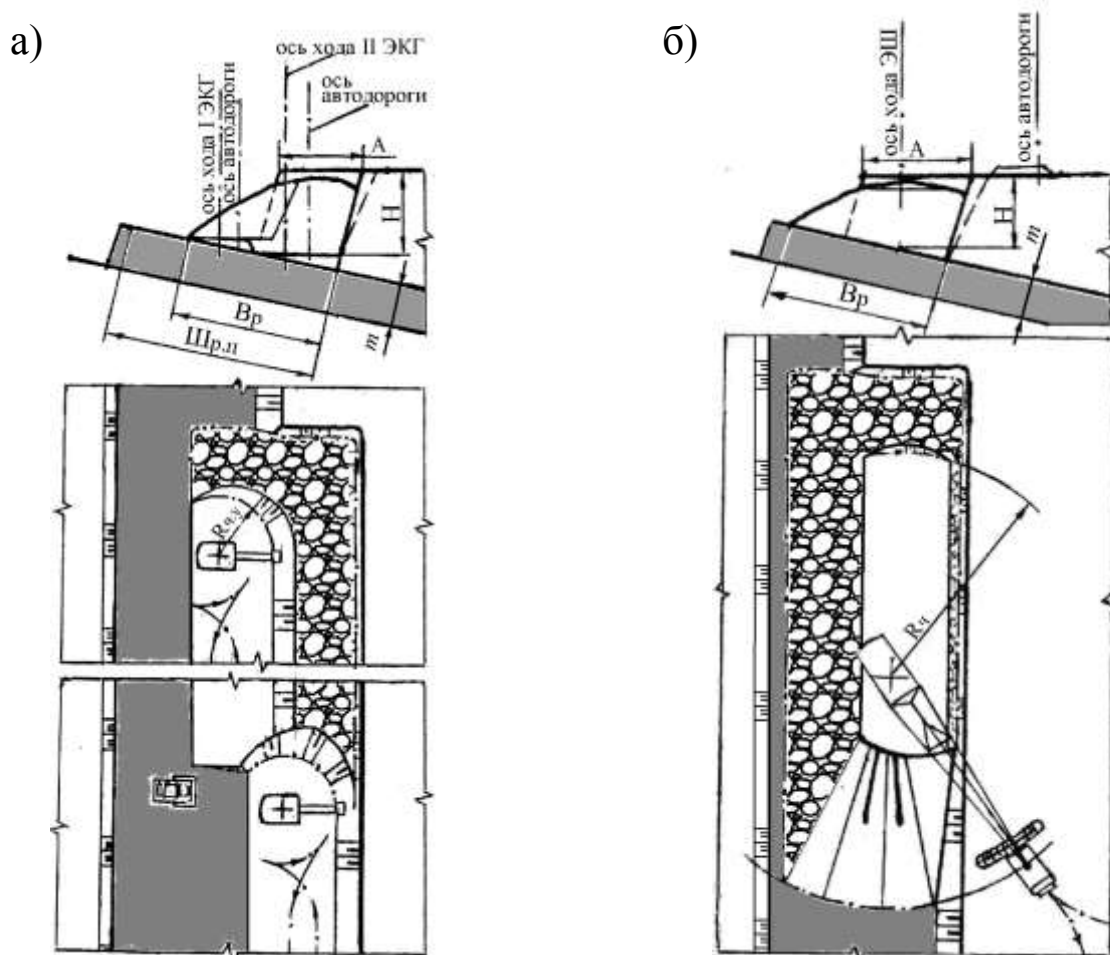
Паспорта забоев для разработки развала вскрышного уступа над пологим угольным пластом: а – прямой механической лопатой; б – шагающим драглайном
